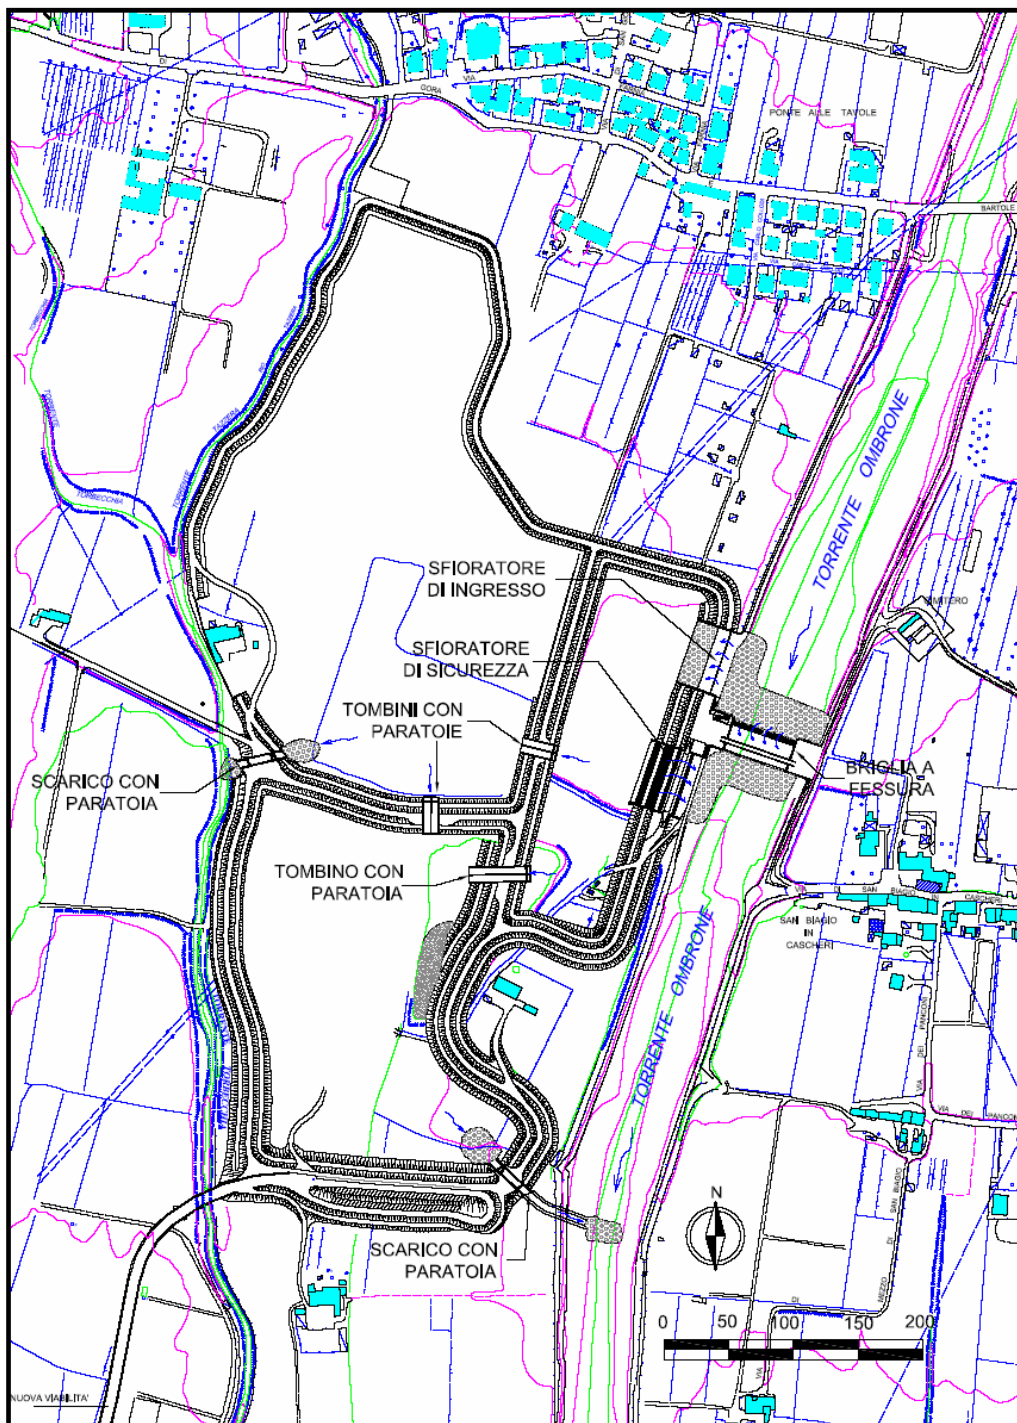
Planimetria della cassa di espansione 'Laghi Primavera'.
